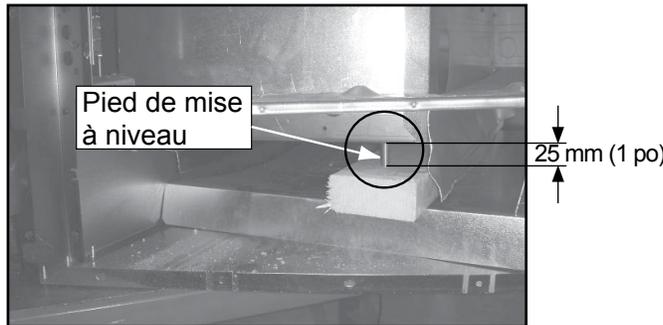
Si le fond est en tôle, nous recommandons d'utiliser les poutrelles de 2 x 4 livrées avec l'emballage du foyer encastré pour servir de soutien. Il se peut qu'il soit nécessaire de couper les poutrelles à la longueur voulue.
